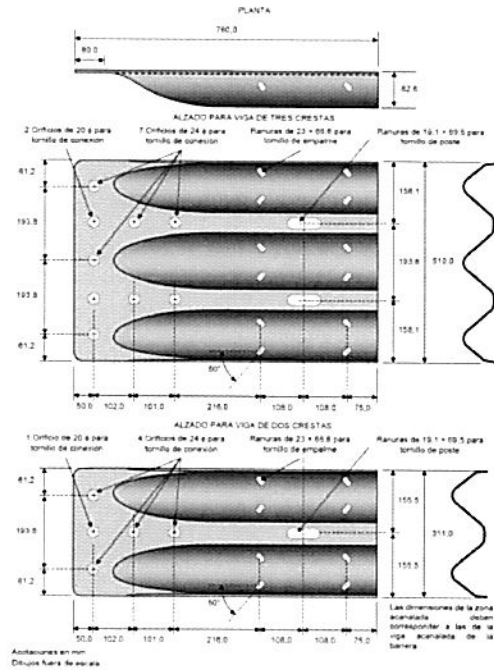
Zapatas de conexión para barreras de vigas acanaladas de acero
